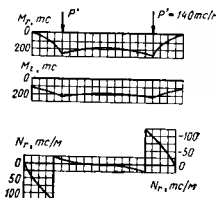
Эпюры расчетных усилий для плиты от нагрузок, передаваемых колоннами
